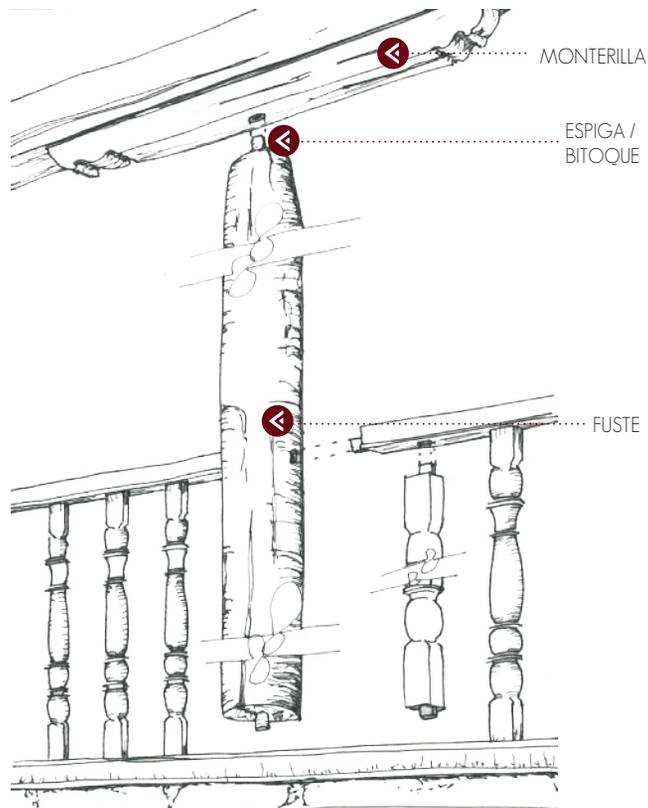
Detalle de unión entre pilar, solera y monterilla.
